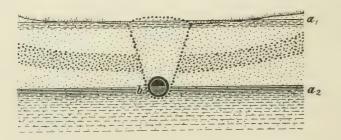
Austrocknung durch Drainage. a_1 Höhe des Grundwasserspiegels vor, a_2 nach Anlage der Drainage, b Drainrohr.
